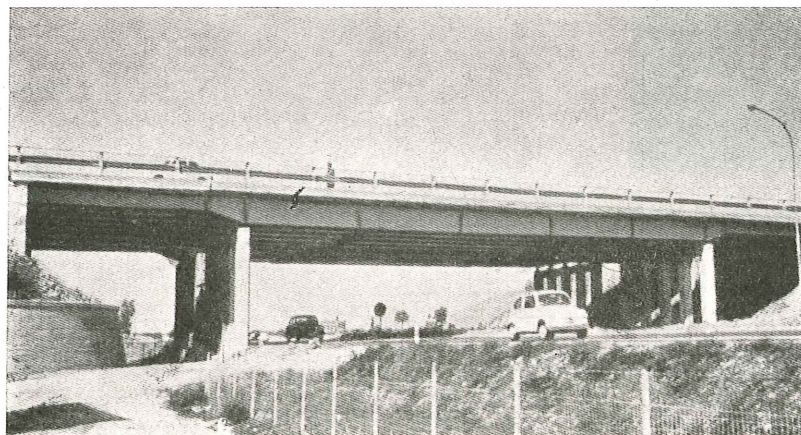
Puente en la autopista del Sol, en el tramo Florencia-Mare. Consta de tres tramos de 9-27-9 m de luz, y está constituido por cinco vigas de un metro de canto, con tablero de 18 cm de espesor. Para el pretensado se utilizó el procedimiento de desbloqueo de las juntas provisionales en la sección metálica.
